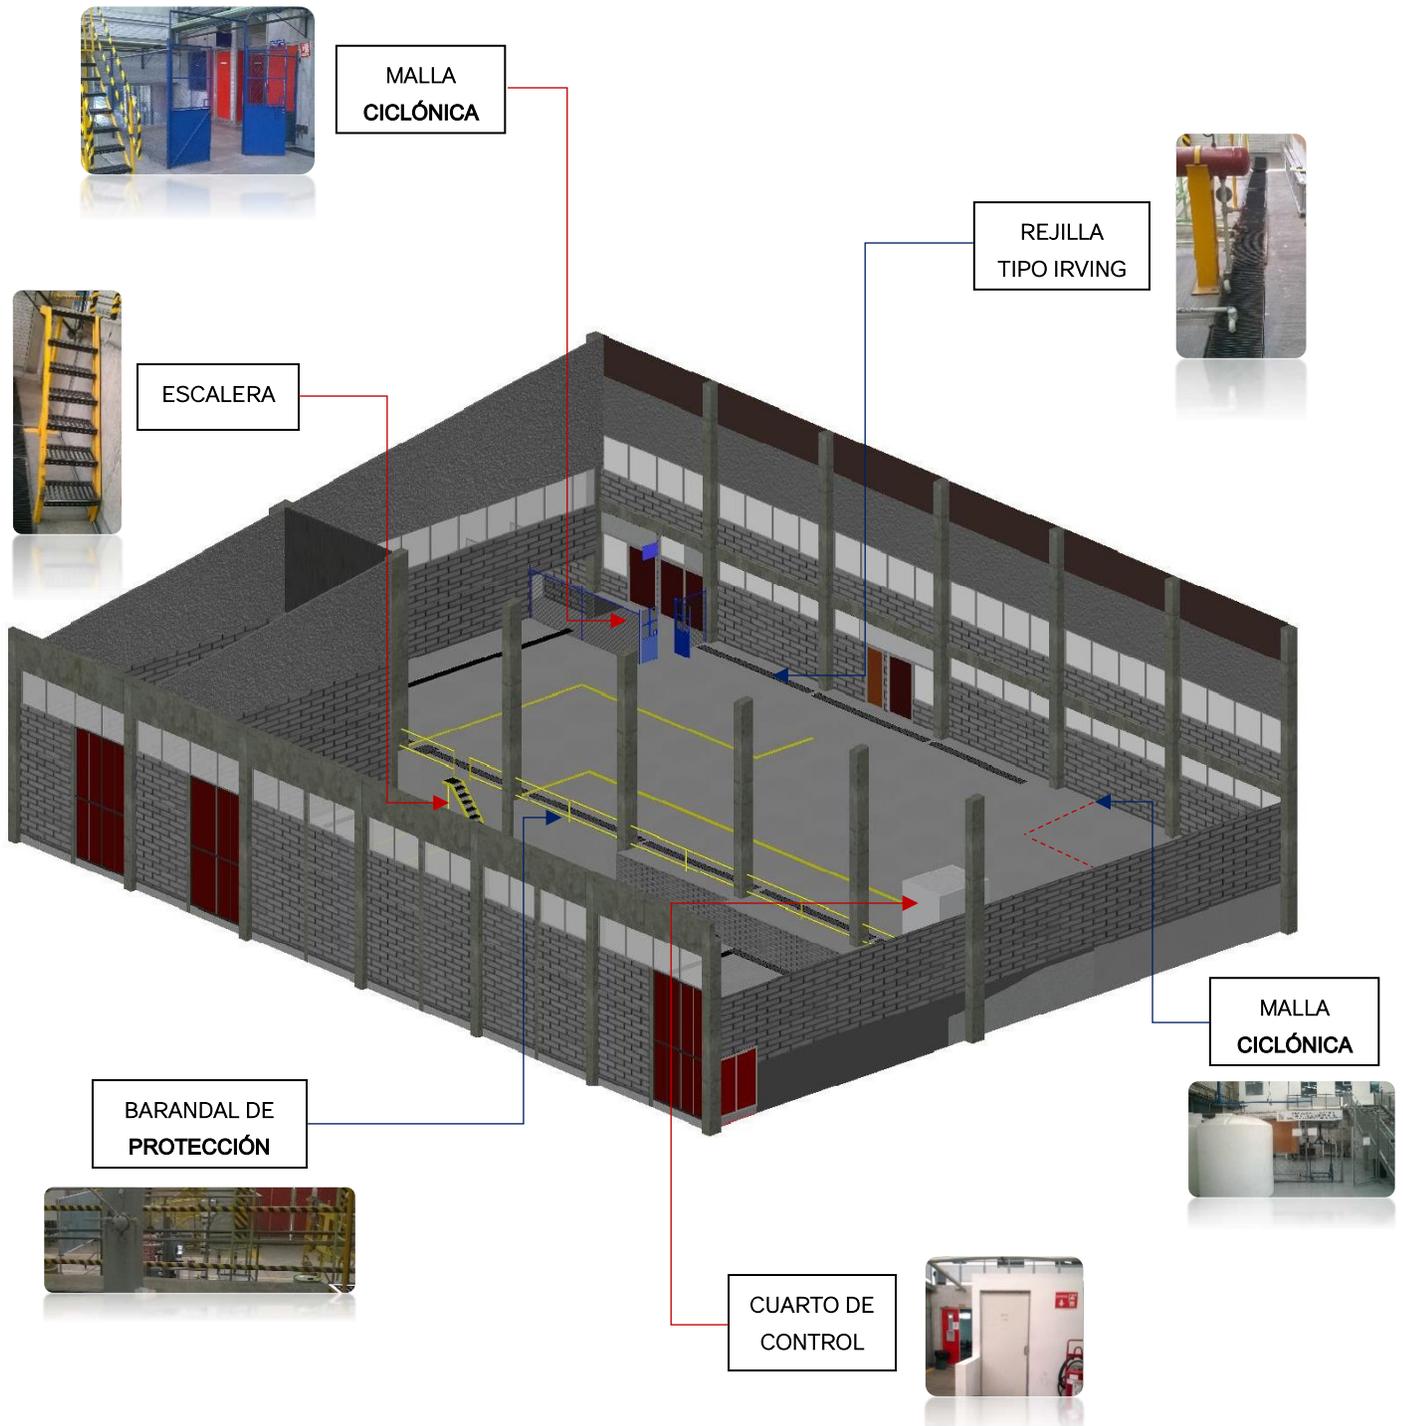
Modelo 3D-Elementos adicionales en Planta Piloto.
